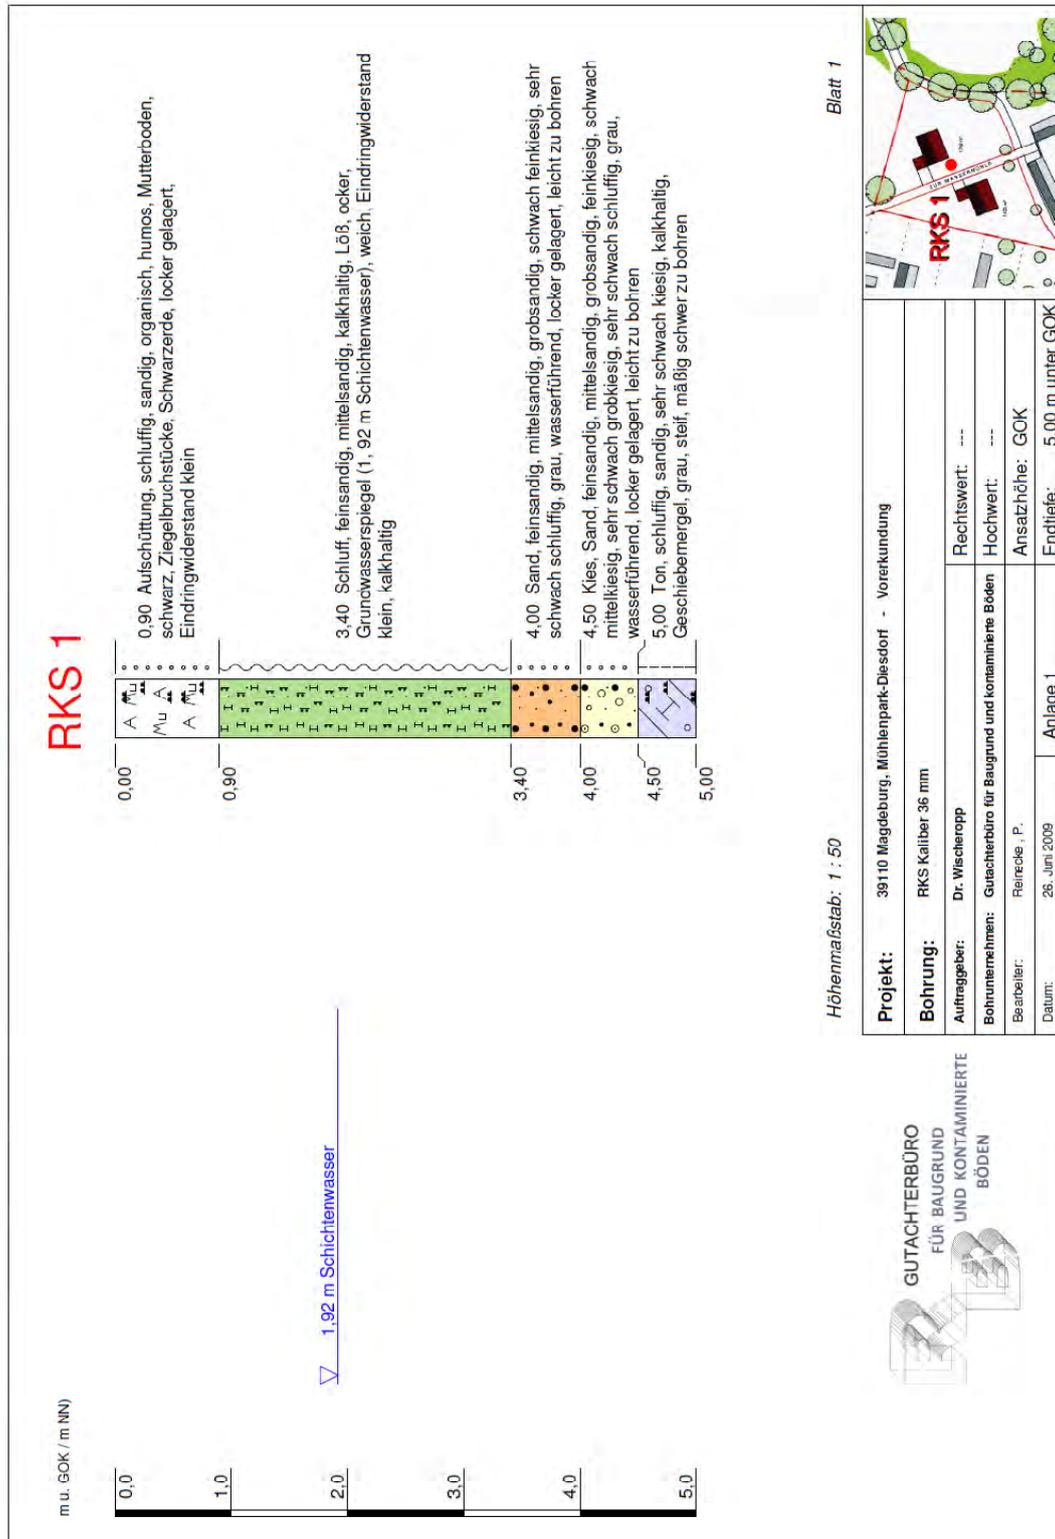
Rammkernsondierung RKS 1
